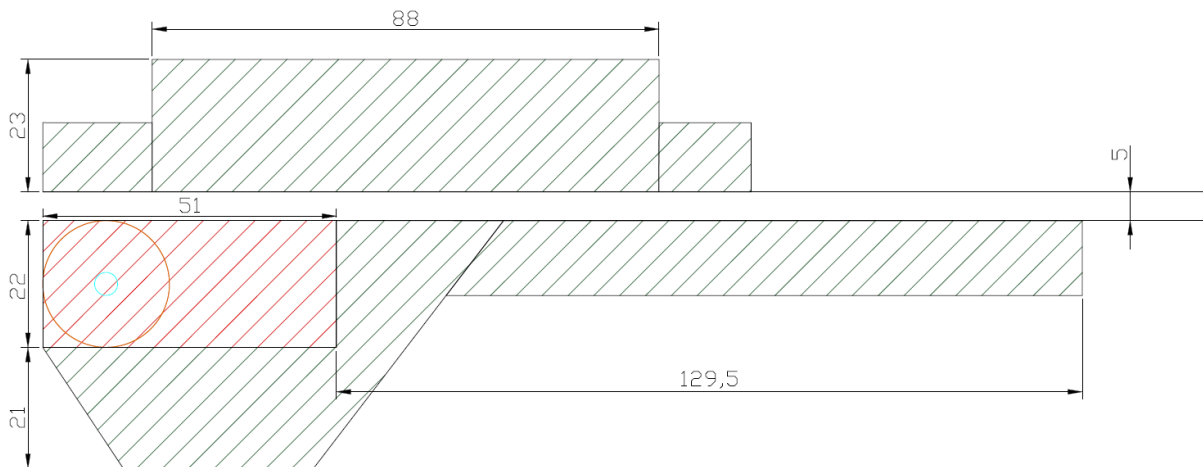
Tipico piazzola di cantiere con quote espresse in metri
